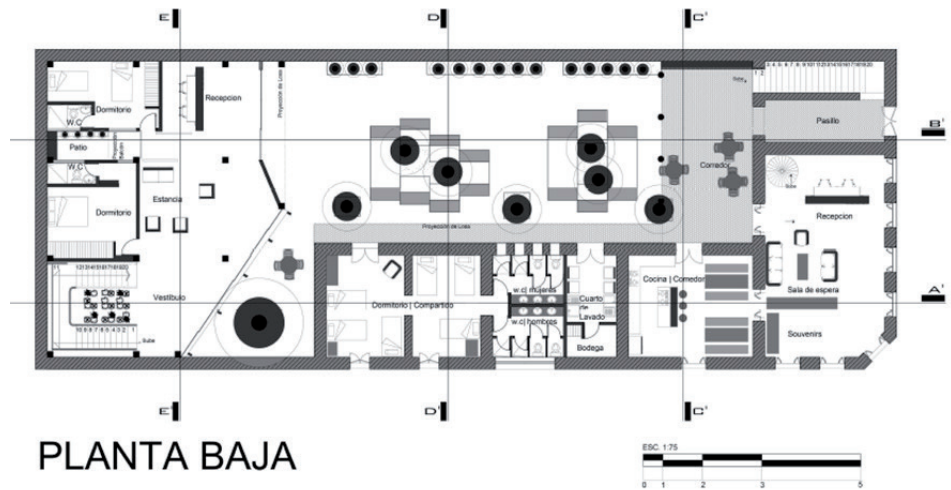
Planta baja y distribución de espacios. Fuente: Tesis (Reyes & Pedrero, 2016)
